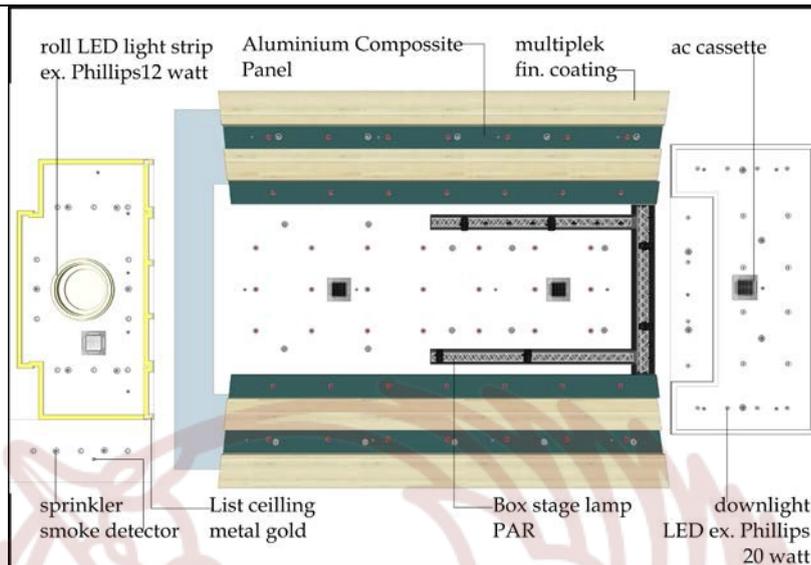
Keputusan akhir ceiling ruang pameran museum
